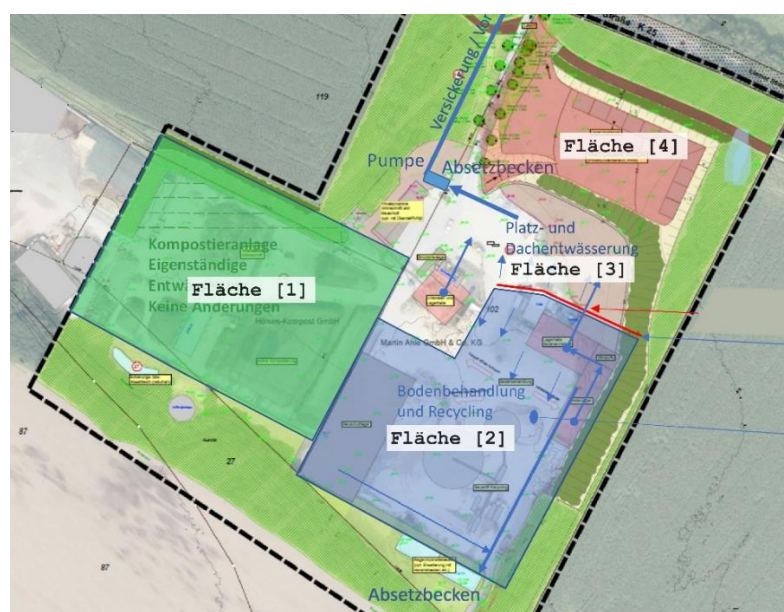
Lageplan Flächenzuordnung (Quelle: Kortemeier Brokmann, Ergänzungen Ahle)
